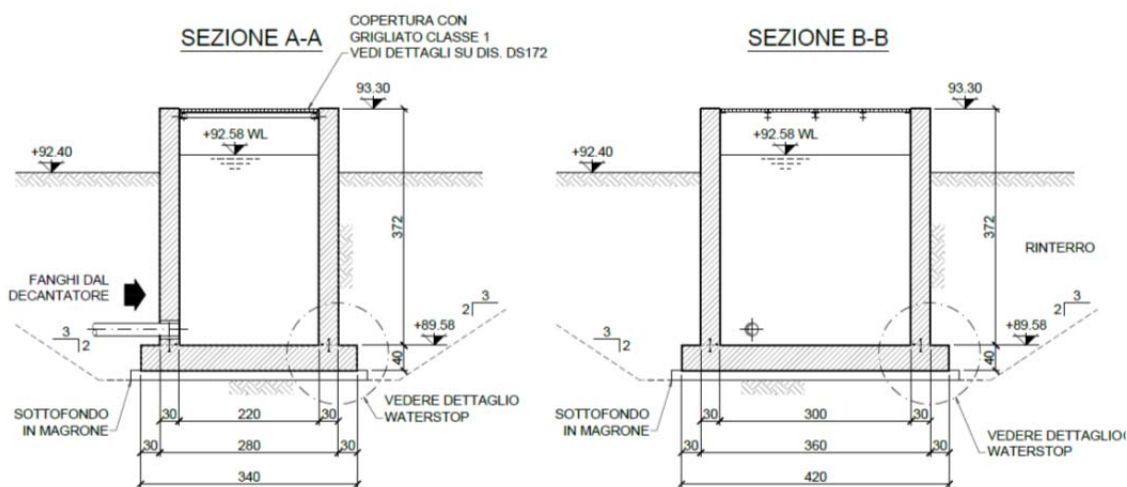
POZZETTO FANGHI – SEZIONI A-A E B-B
